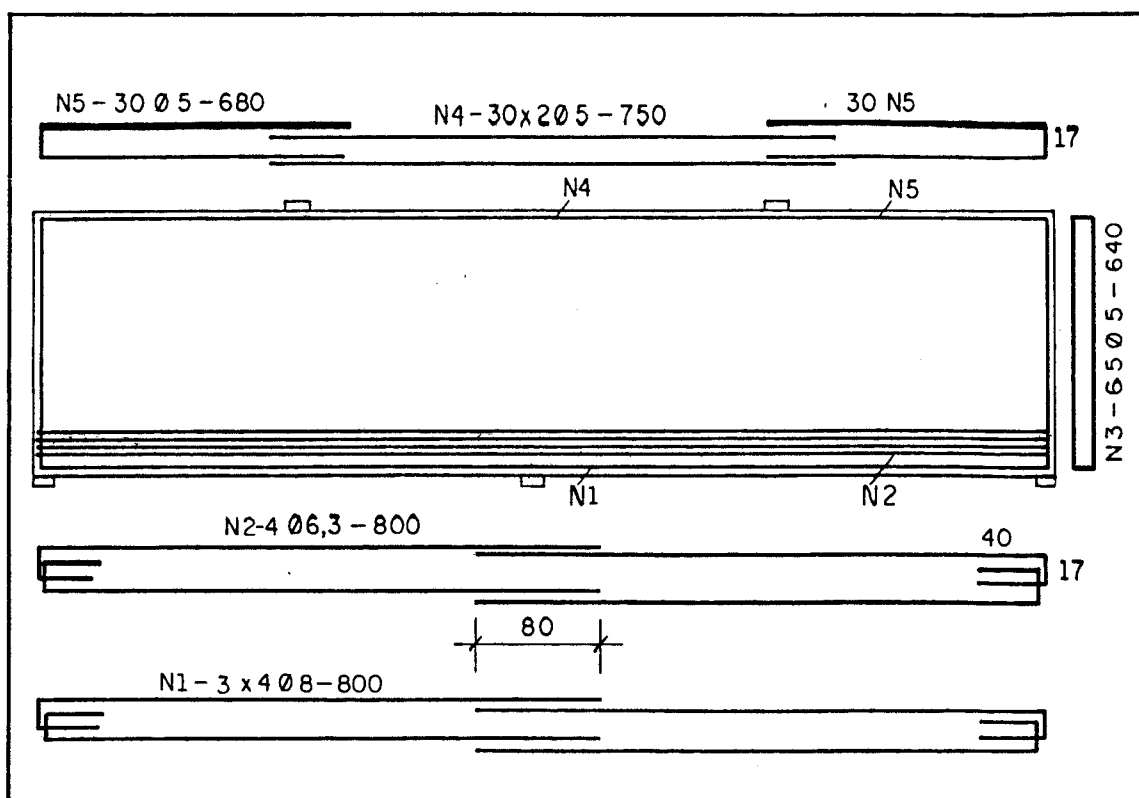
Detalhamento da viga-parede do exemplo 5.
